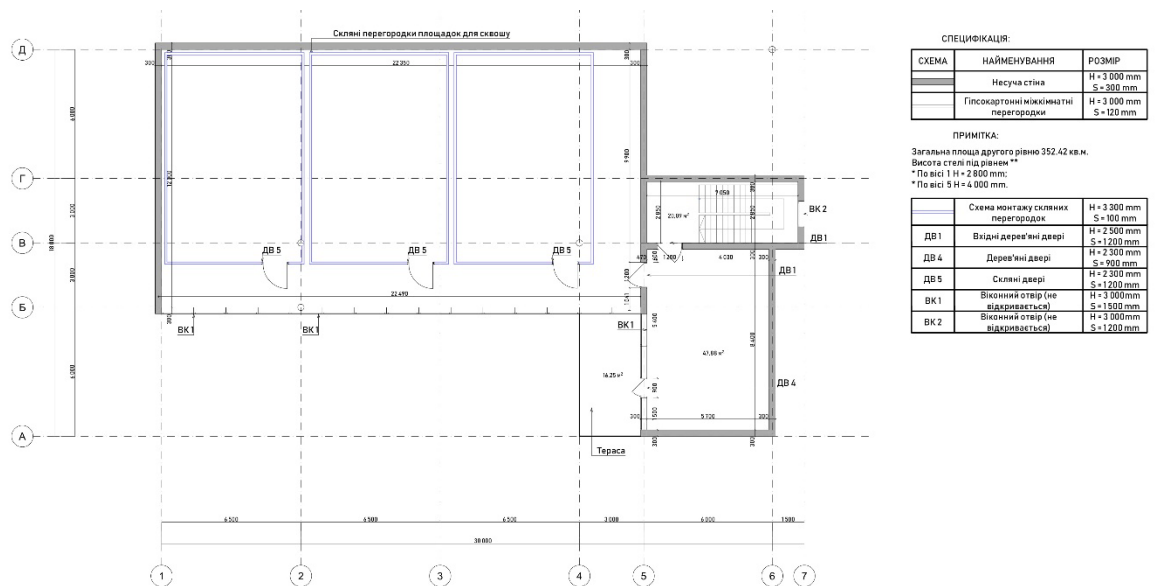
Схема монтажу міжкімнатних перегородок другого рівню
